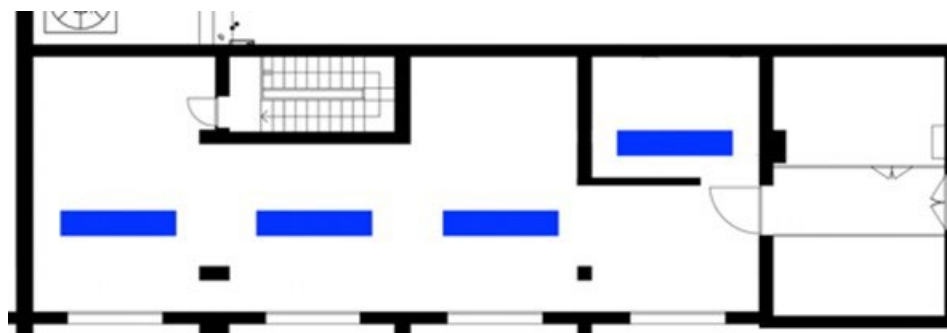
Planimetria del laboratorio con il posizionamento dei corpi illuminanti.
